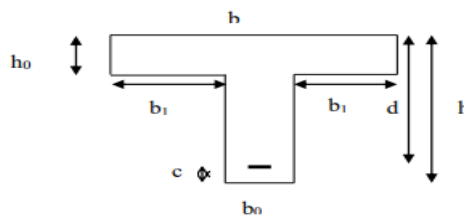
Section de calcul de la poutrelle après coulage de la dalle de compression (Section en T)
